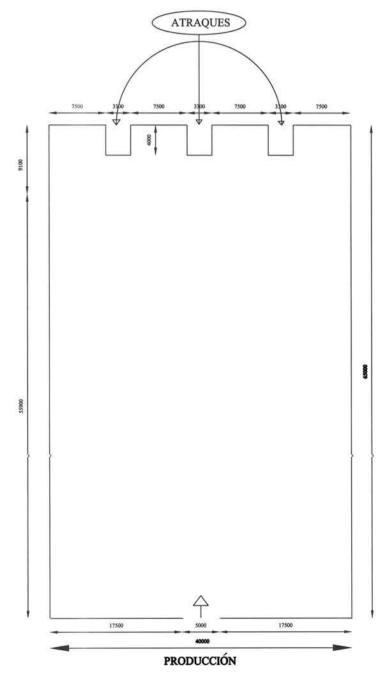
Lay-out*; pasillos transversales, carretilla contrapesada, estantería *drive-in
